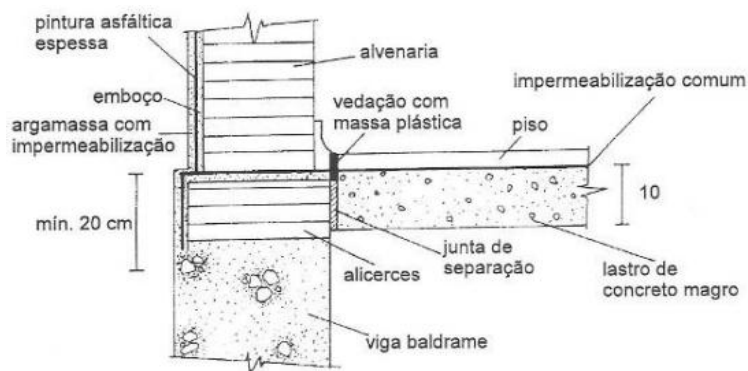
Impermeabilização de subsolo em terreno úmido.
